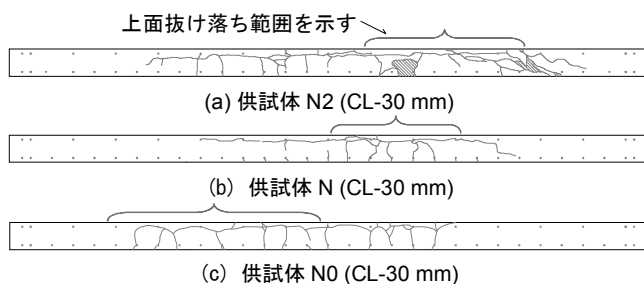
輪荷重走行位置直下の断面のひび割れ図
